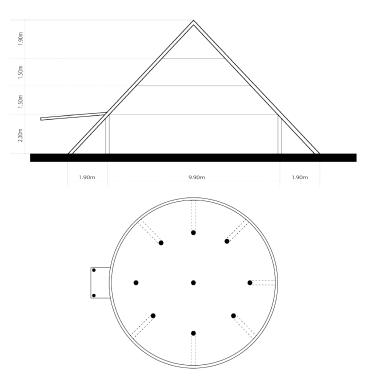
Corte y Planta Vivienda Cónica Fuente: Elaborado por autor
